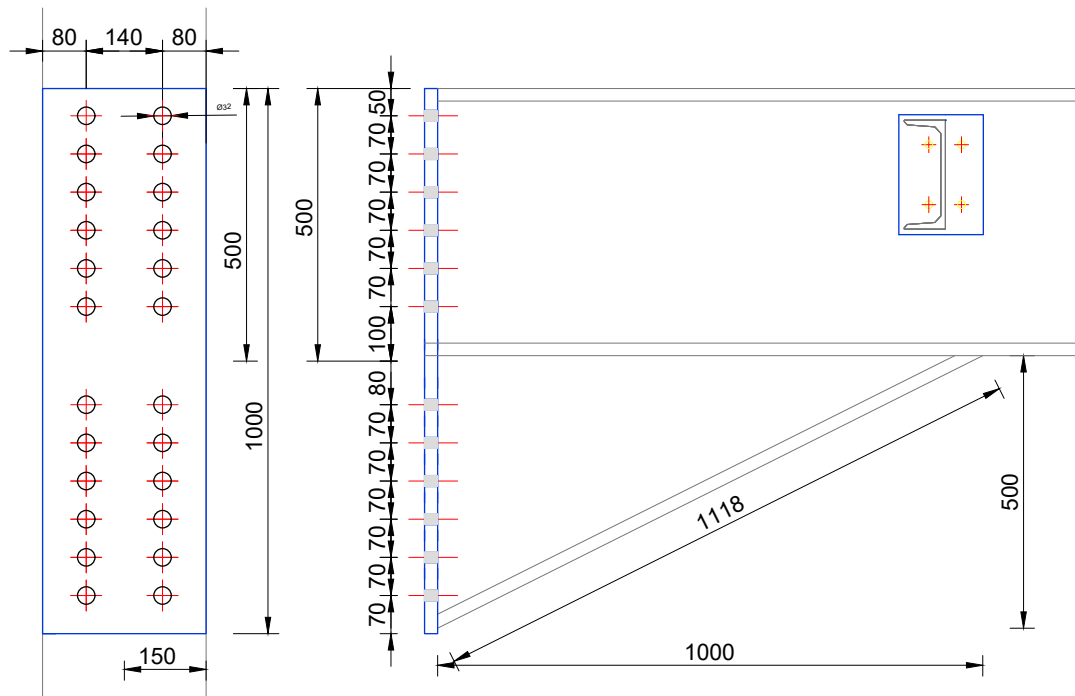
Vue générale de l'assemblage poutre-poteau
